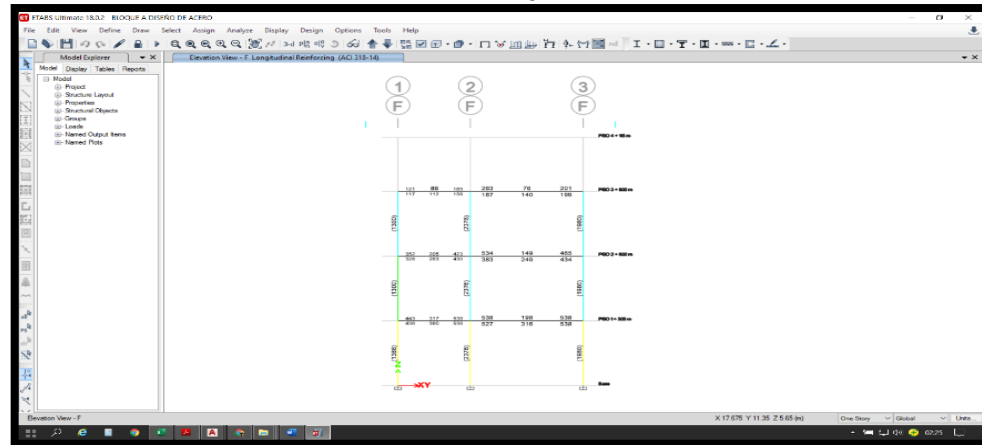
Bloque B - Acero longitudinal en el eje elevación eje F-F
